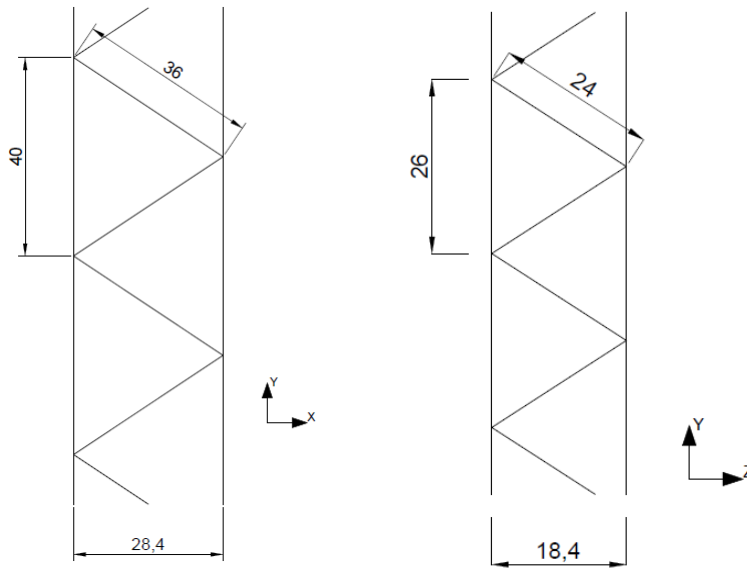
Vistas laterales de la columna (dimensiones relevadas)
